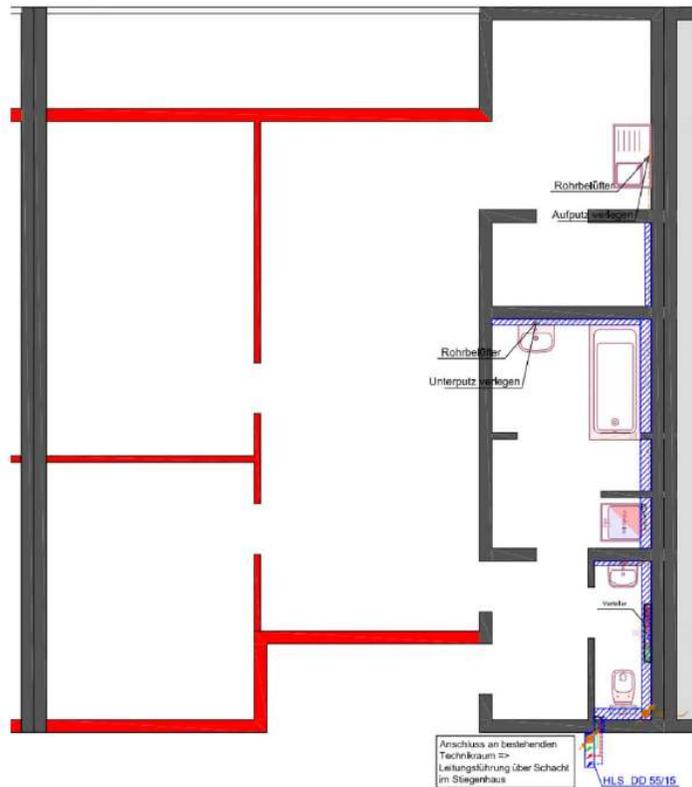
Leitungsschema ROOFBOX. Quelle: TBH Ingenieur GmbH
